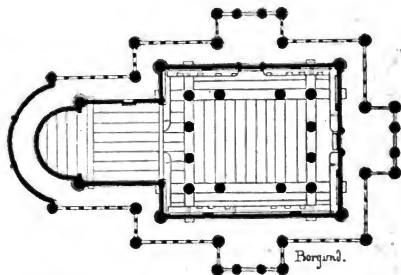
Grundriss der Kirche zu Borgund. (Nach G. Bull.)
